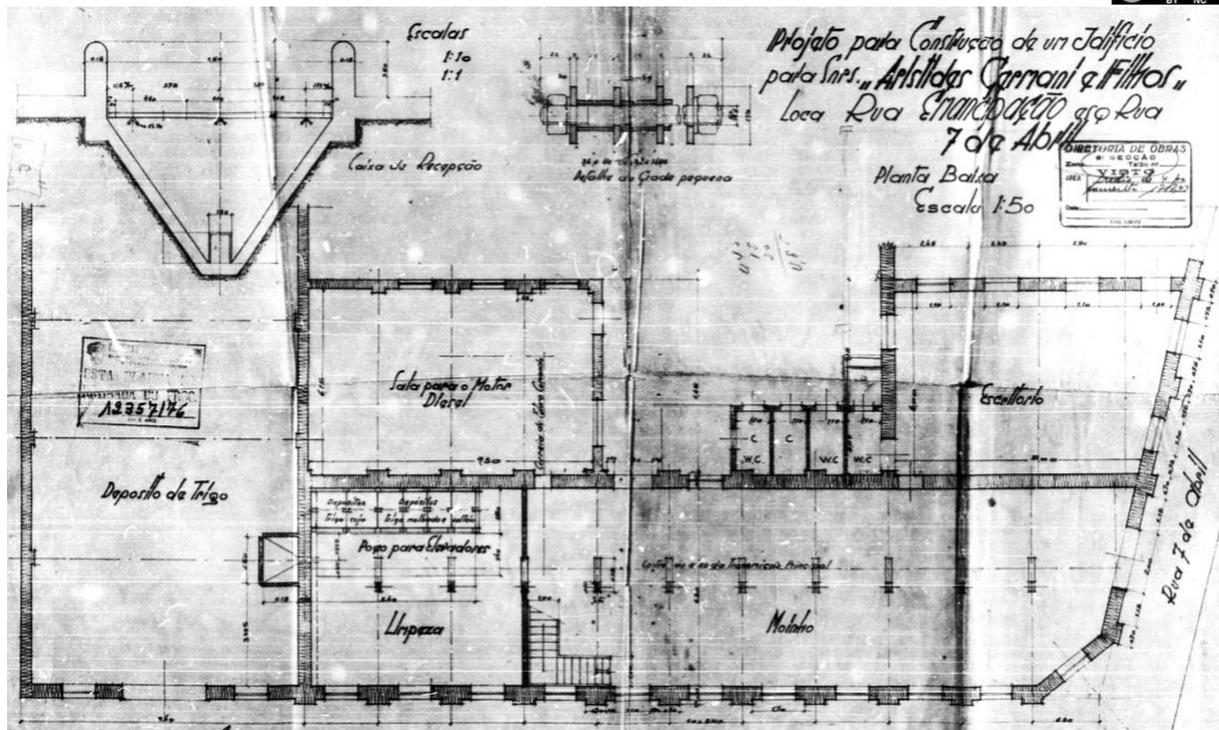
Planta Baixa Original, 1941. Fonte: Arquivo Municipal de Porto Alegre, 1941.
